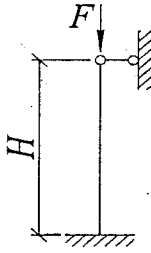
Розрахункова схема центрально стиснутої зварної колони
